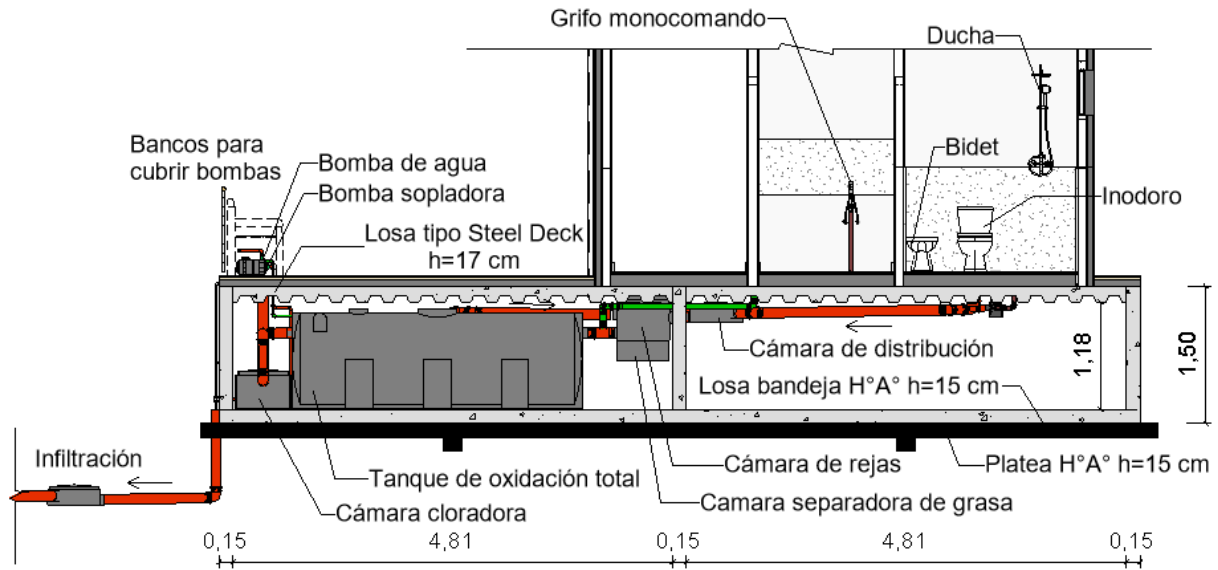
Ubicación de las cámaras y la planta de oxidación total.
